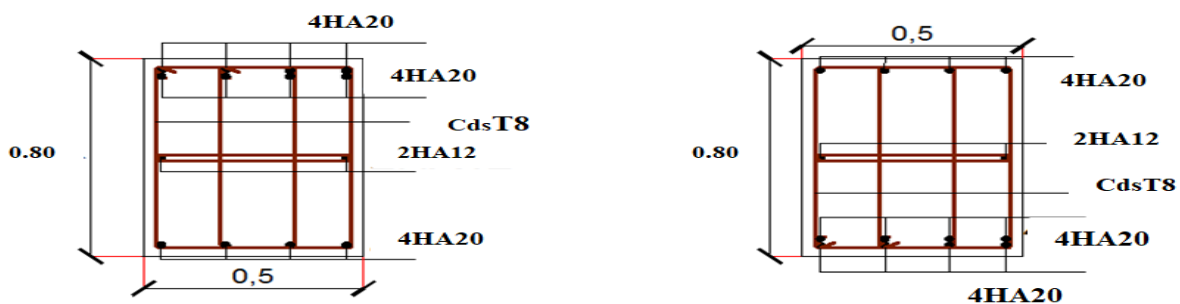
Ferrailage de la nervure en travées et en appuis
